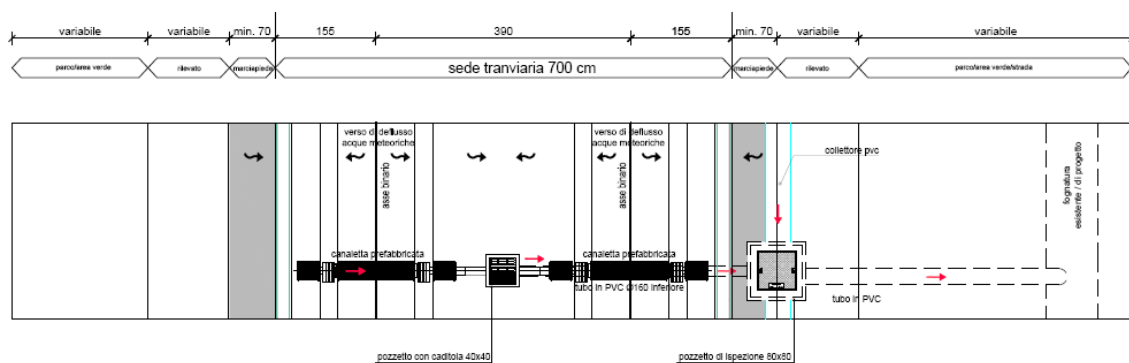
stralcio planimetrico sede tranviaria in prossimità di aree verdi
